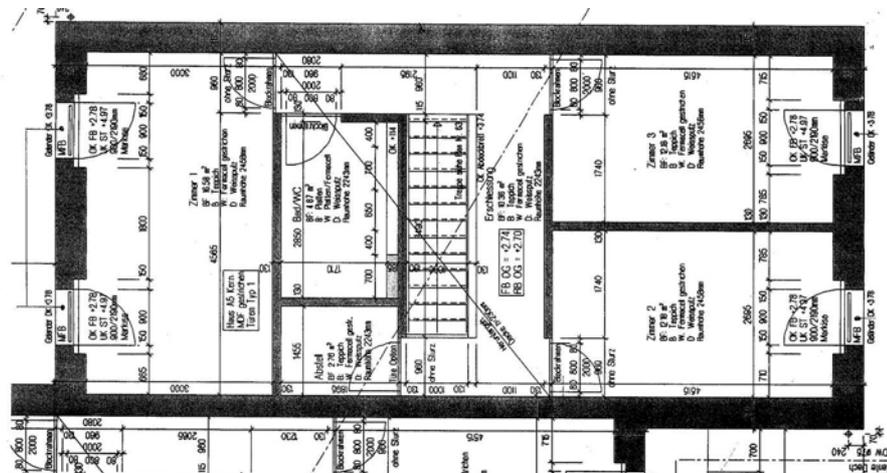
Grundriss Obergeschoss Haus „Wegere“
